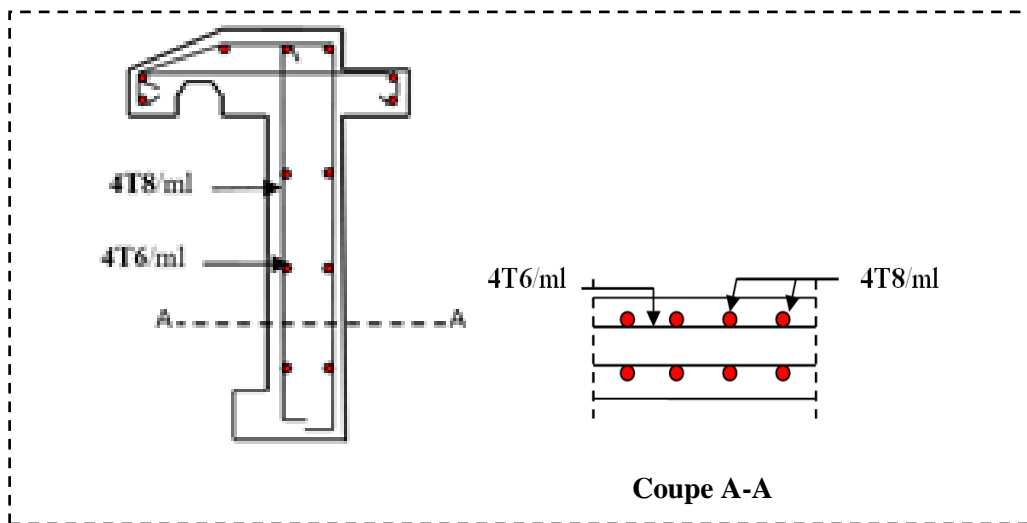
Schéma de ferrailage de l'acrotère (Terrasse inaccessible).
